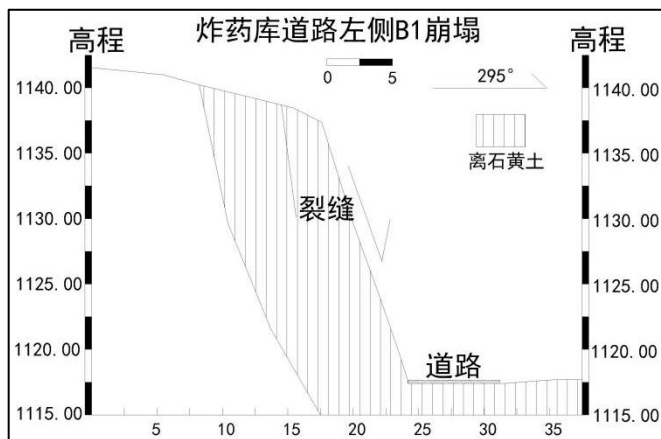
炸药库道路左侧 B1 崩塌剖面图
